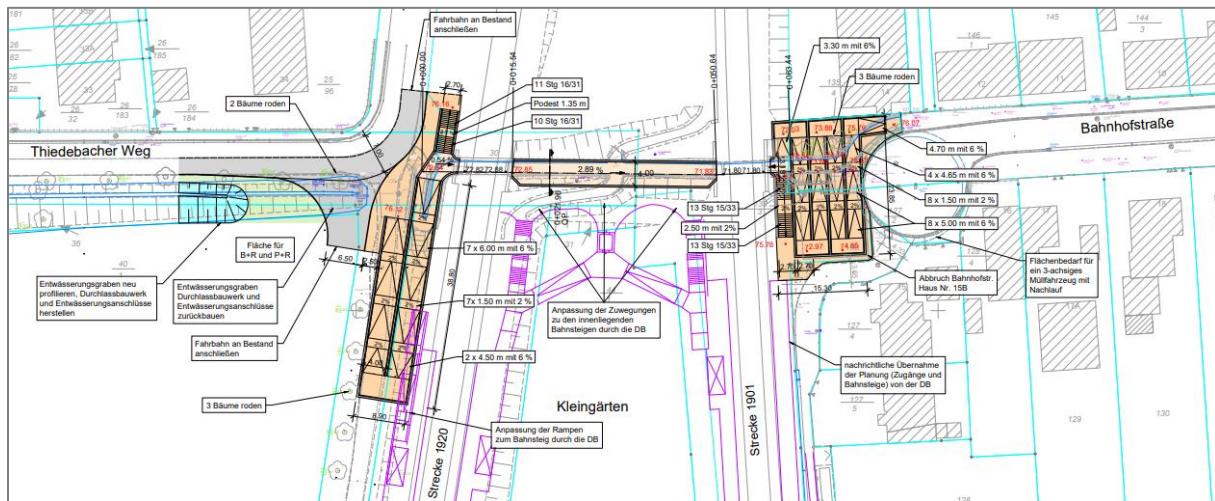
Variante 2 – barrierefreie Unterführung mit Rampen
